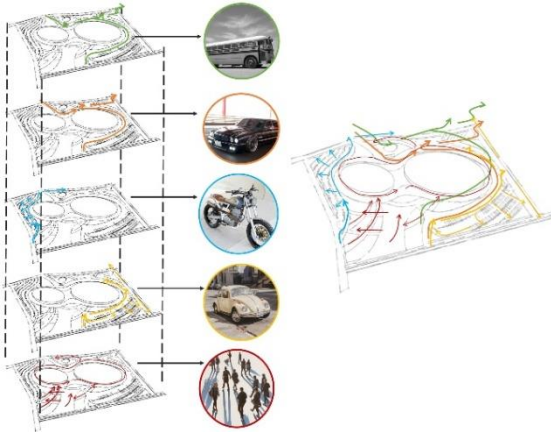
Site Plan Stadion Aquatik Kuta Malaka
